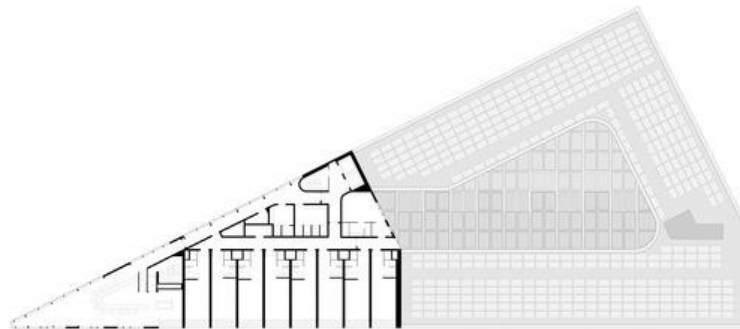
Planta Baixa pavimento tipo 1 Hotel Jakarta.
